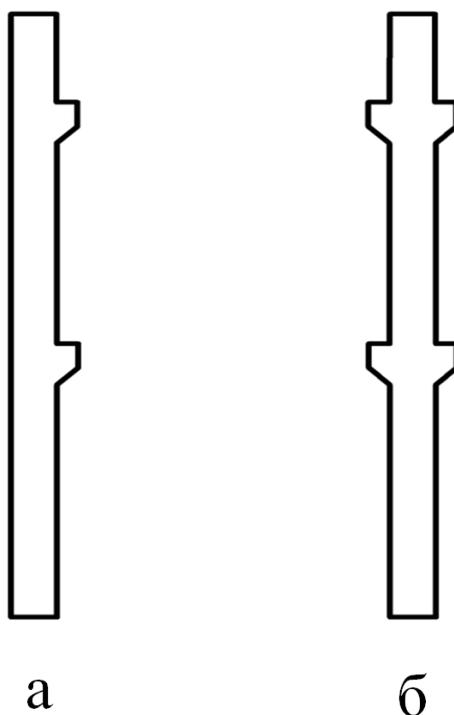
Железобетонные колонны для многоэтажных зданий:
